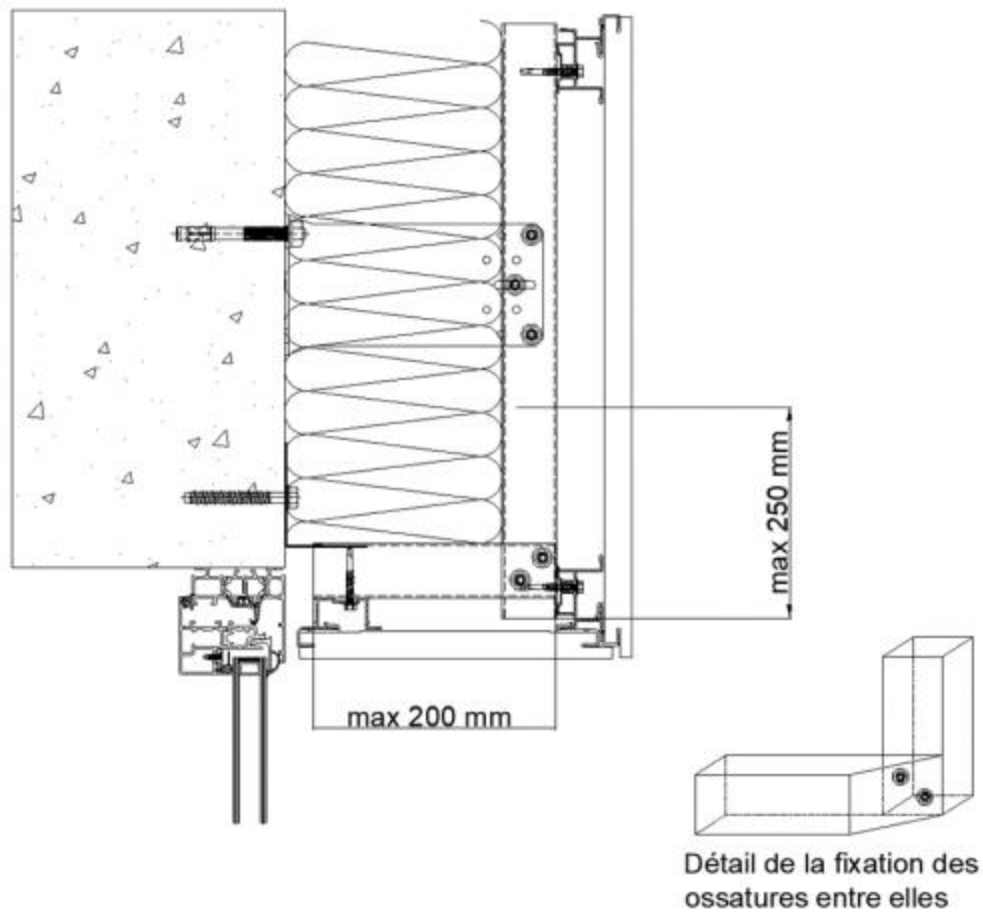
Linteau habillage pierre sur rail RV menuiserie en tunnel
